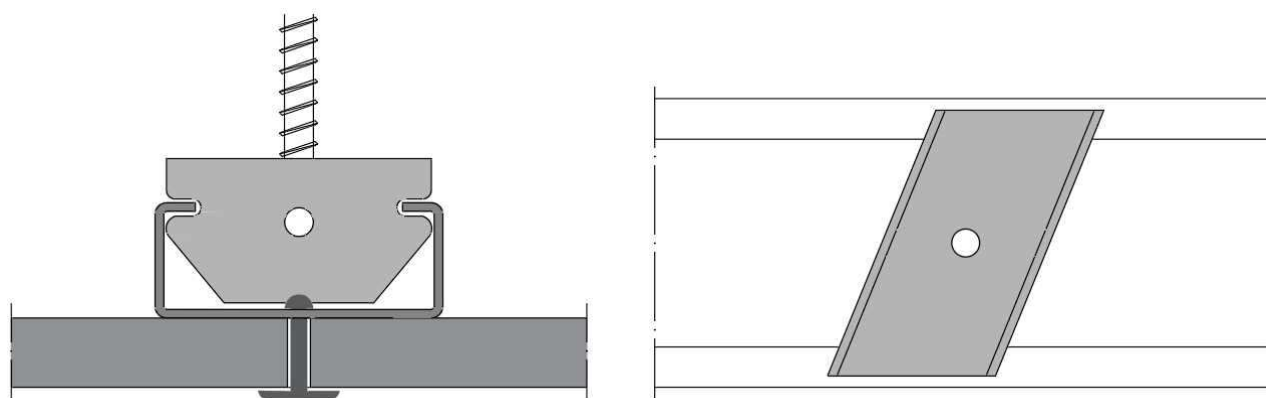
Pormenor de fixação do painel ao perfil de suporte
